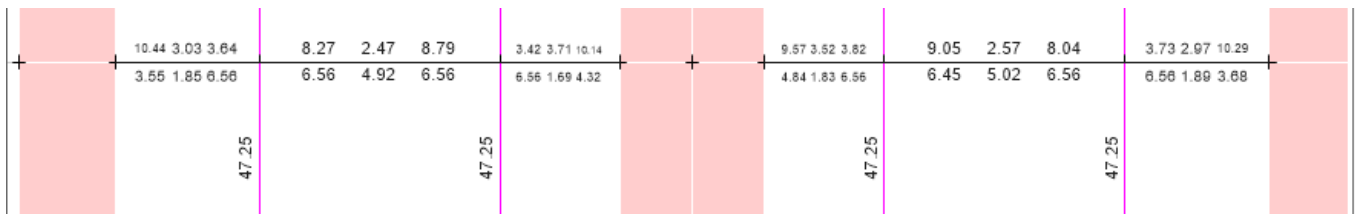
Acero Requerido por momentos en Vigas 7° Piso
